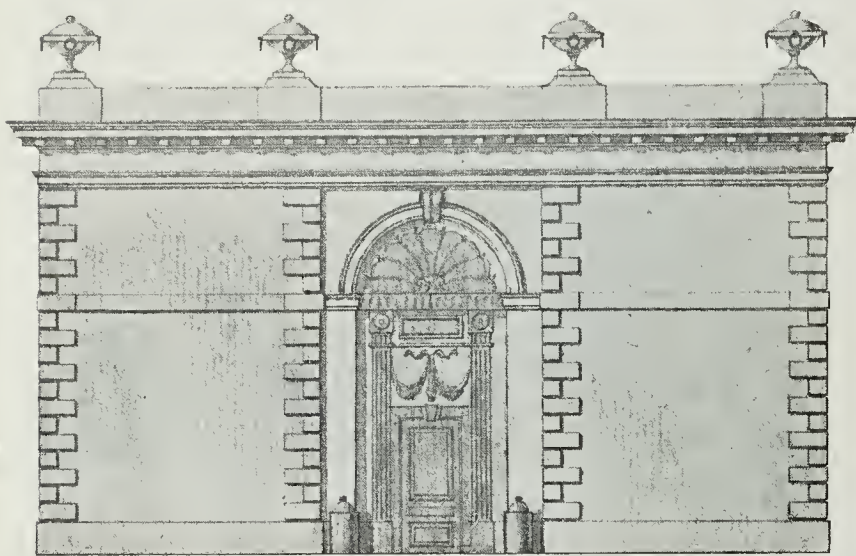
Projekteret Façademur til Staldgaarden i Ny Vestergade.
